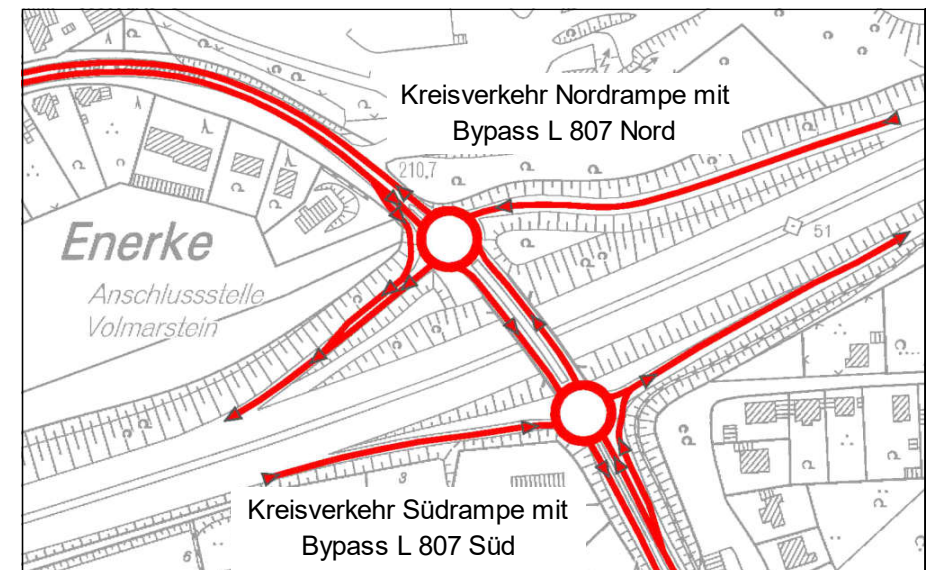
Geplante Verkehrsführung Autobahnanschlussstelle
